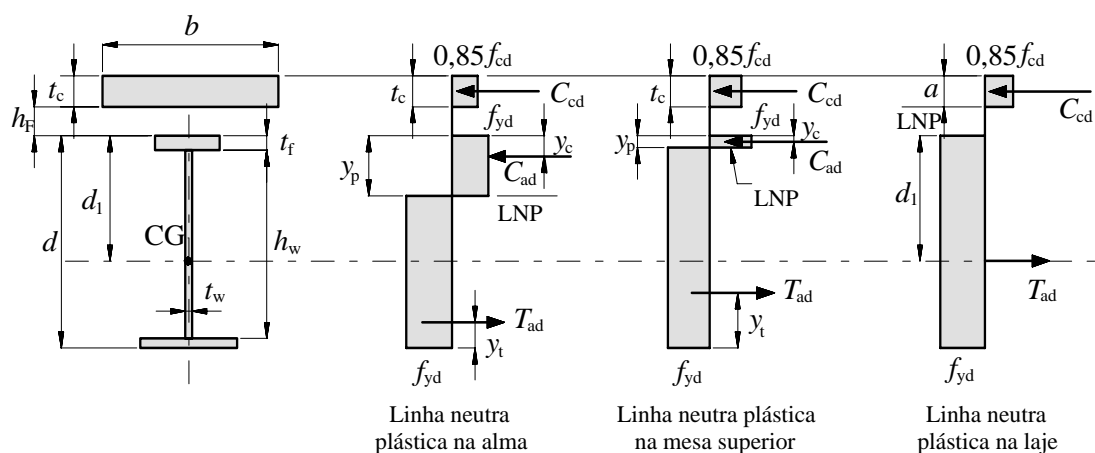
Possíveis posições da linha neutra plástica para viga mista (NBR 8800:2008).
